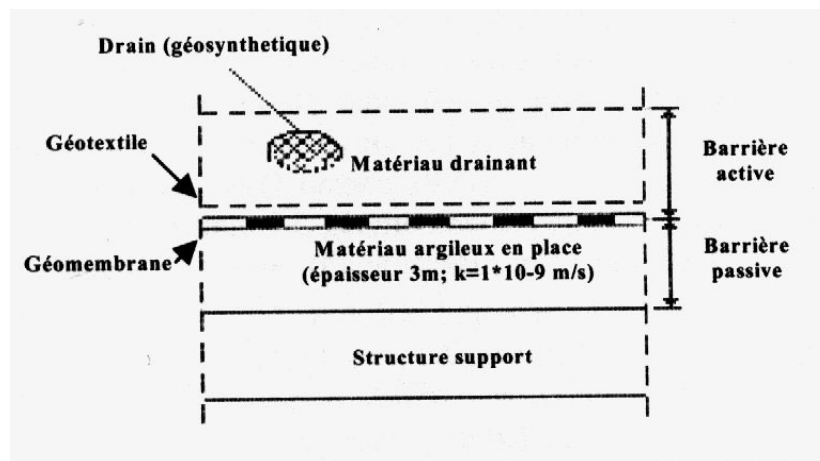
Exemple type de structure de fond d'un CSD, classe II, avec son dispositif d'étanchéité-drainage
